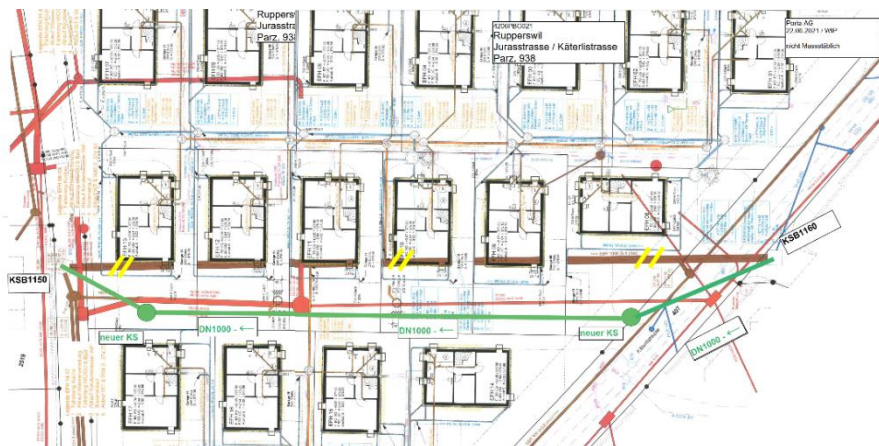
Planausschnitt Bauvorhaben, projektierte Kanalisation in Grün (Variante West)
